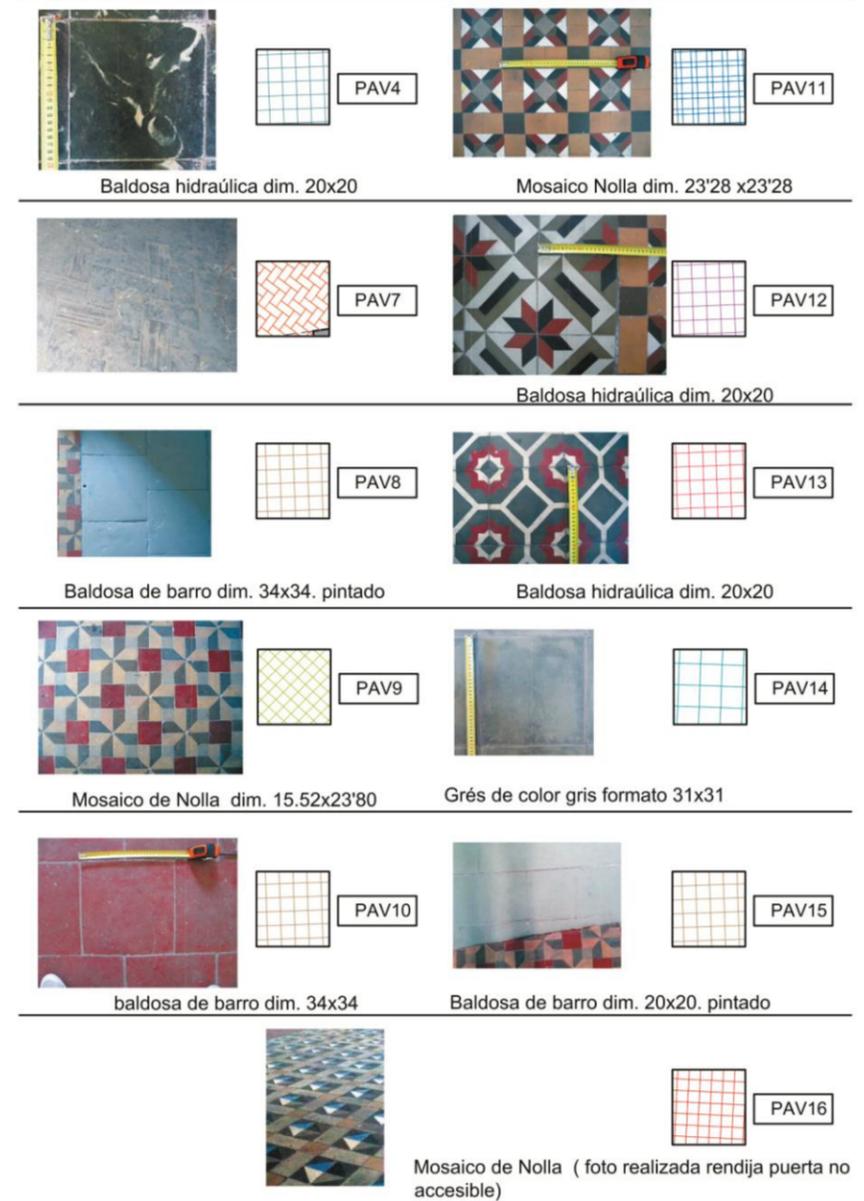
Pavimentos existentes en planta primera Fuente: Propia
